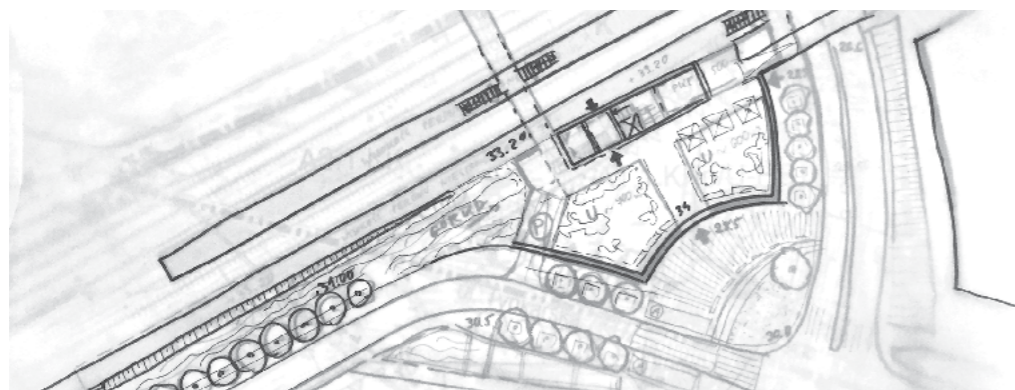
Plac przed stacją i pierwsza kondygnacja budynku wielofunkcyjnego w wariantie intensywnym
